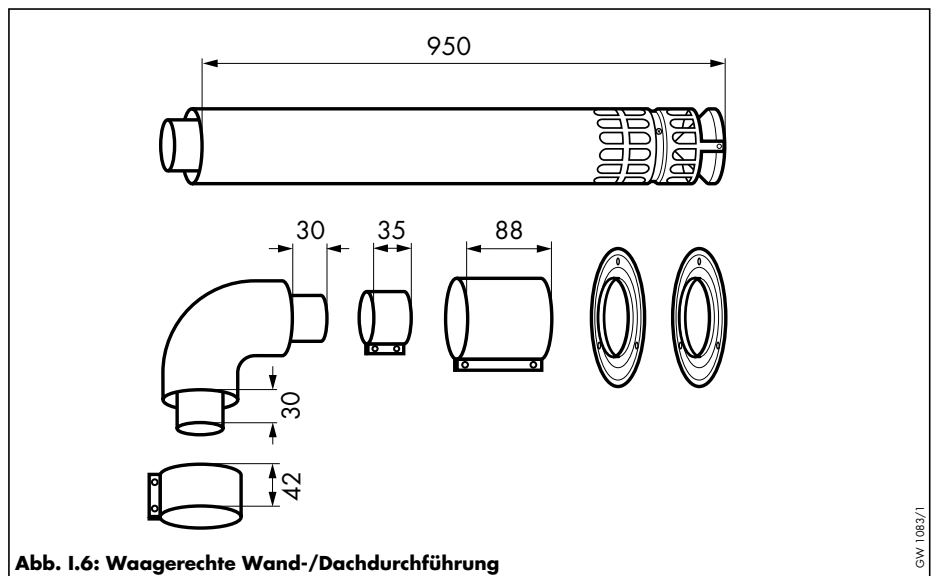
Waagerechte Wand-/Dachdurchführung
